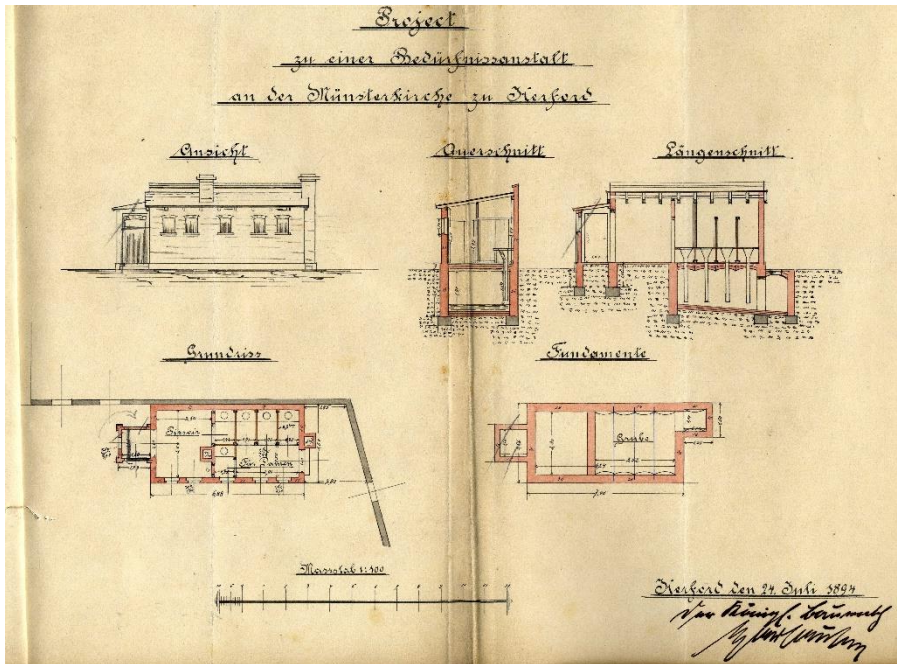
Bauplan der Bedürfnisanstalt auf dem Münsterkirchplatz
